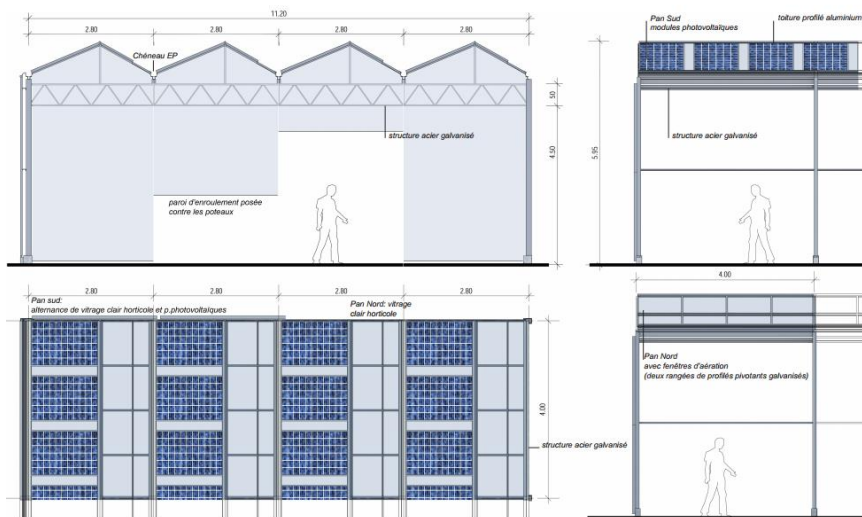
Extrait du PCS : plan des façades et toiture joint au dossier de demande de permis de construire
